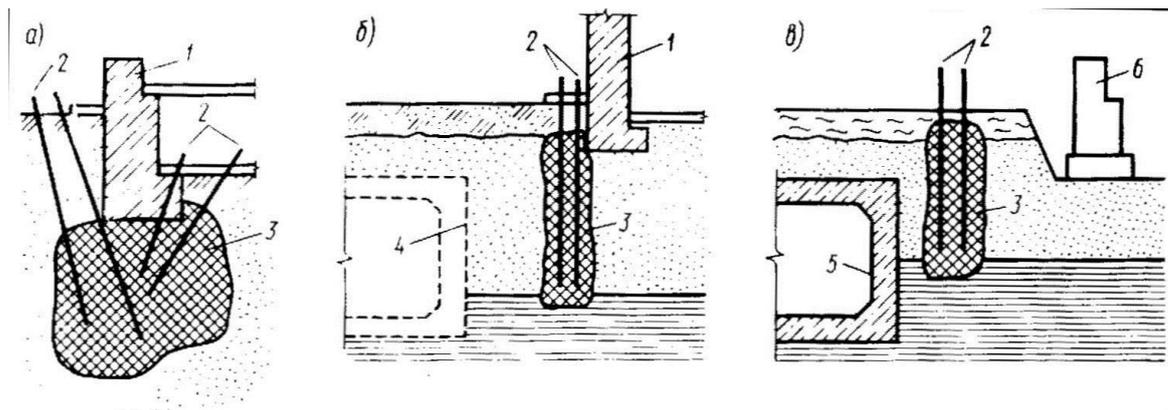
Схемы закрепления методом силикатизации оснований фундаментов (а), защиты фундаментов зданий при строительстве подземных сооружений (б), при возведении зданий (в):
